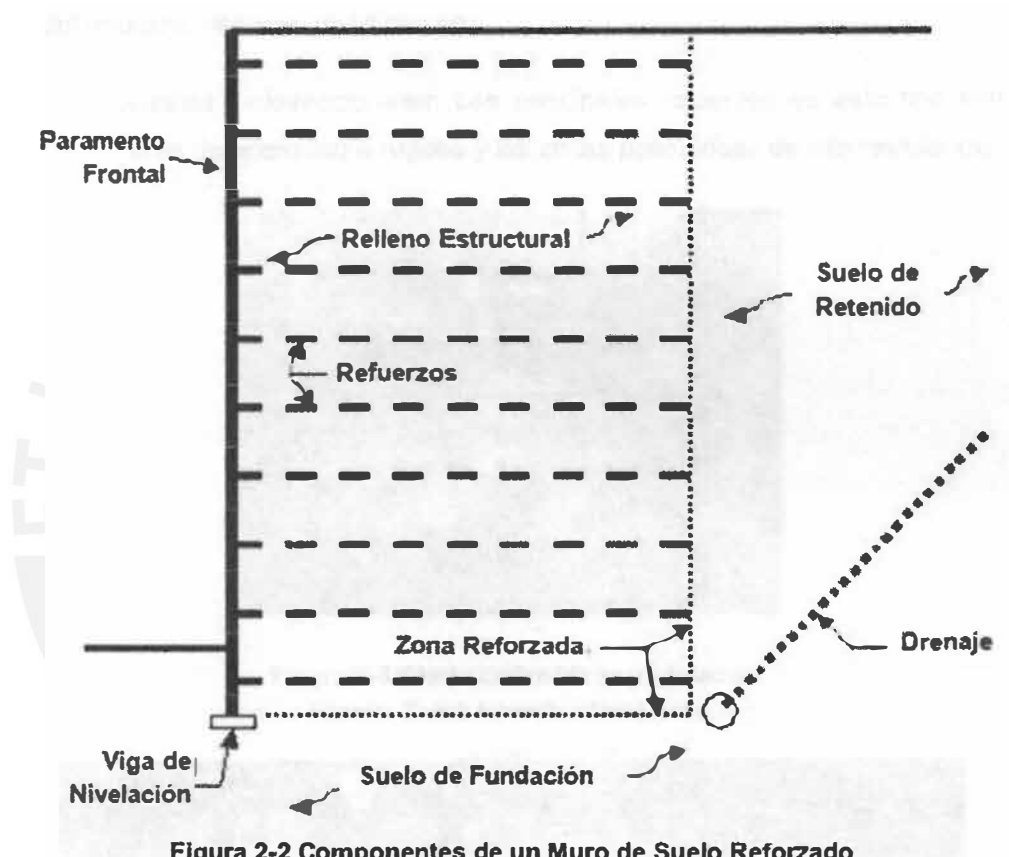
Componentes de un Muro de Suelo Reforzado
